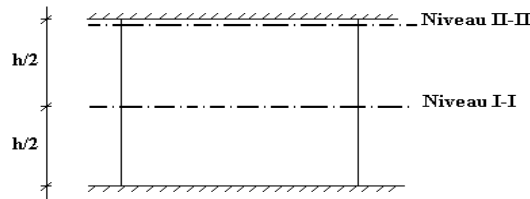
Schéma d'un voile plein et disposition du ferrailage
